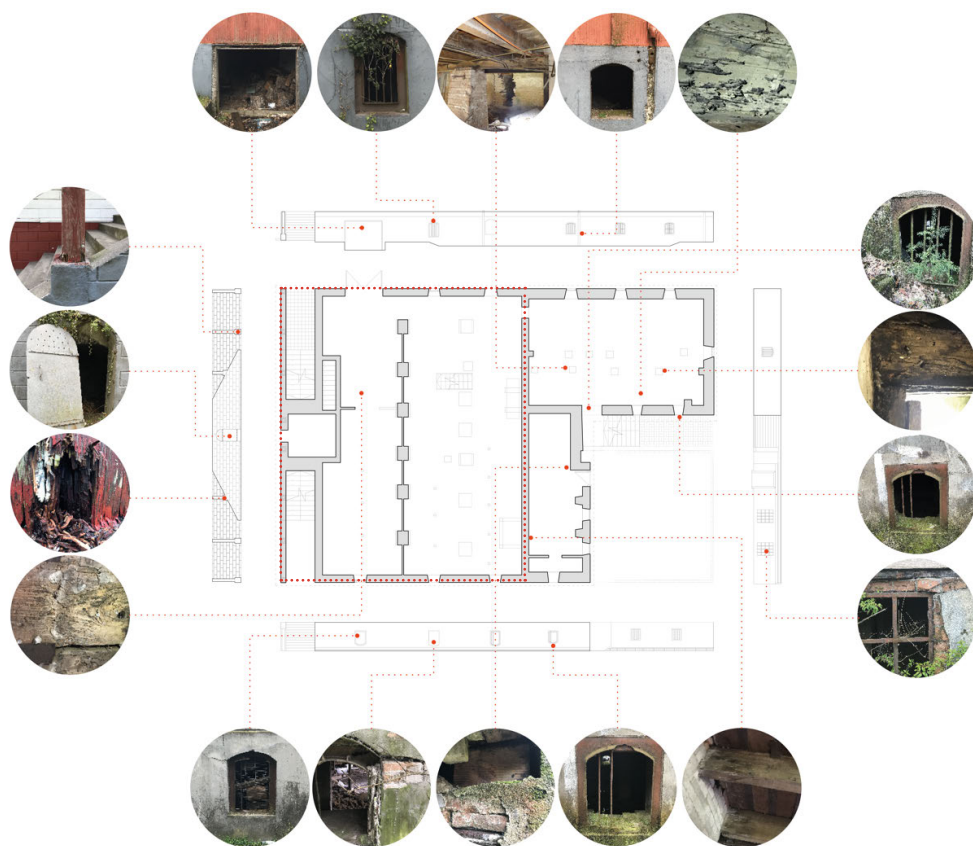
Planta nivel zócalo; el rectángulo rojo es el perfil original según Guarda (1980). (fuente: elaboración propia, 2022).
